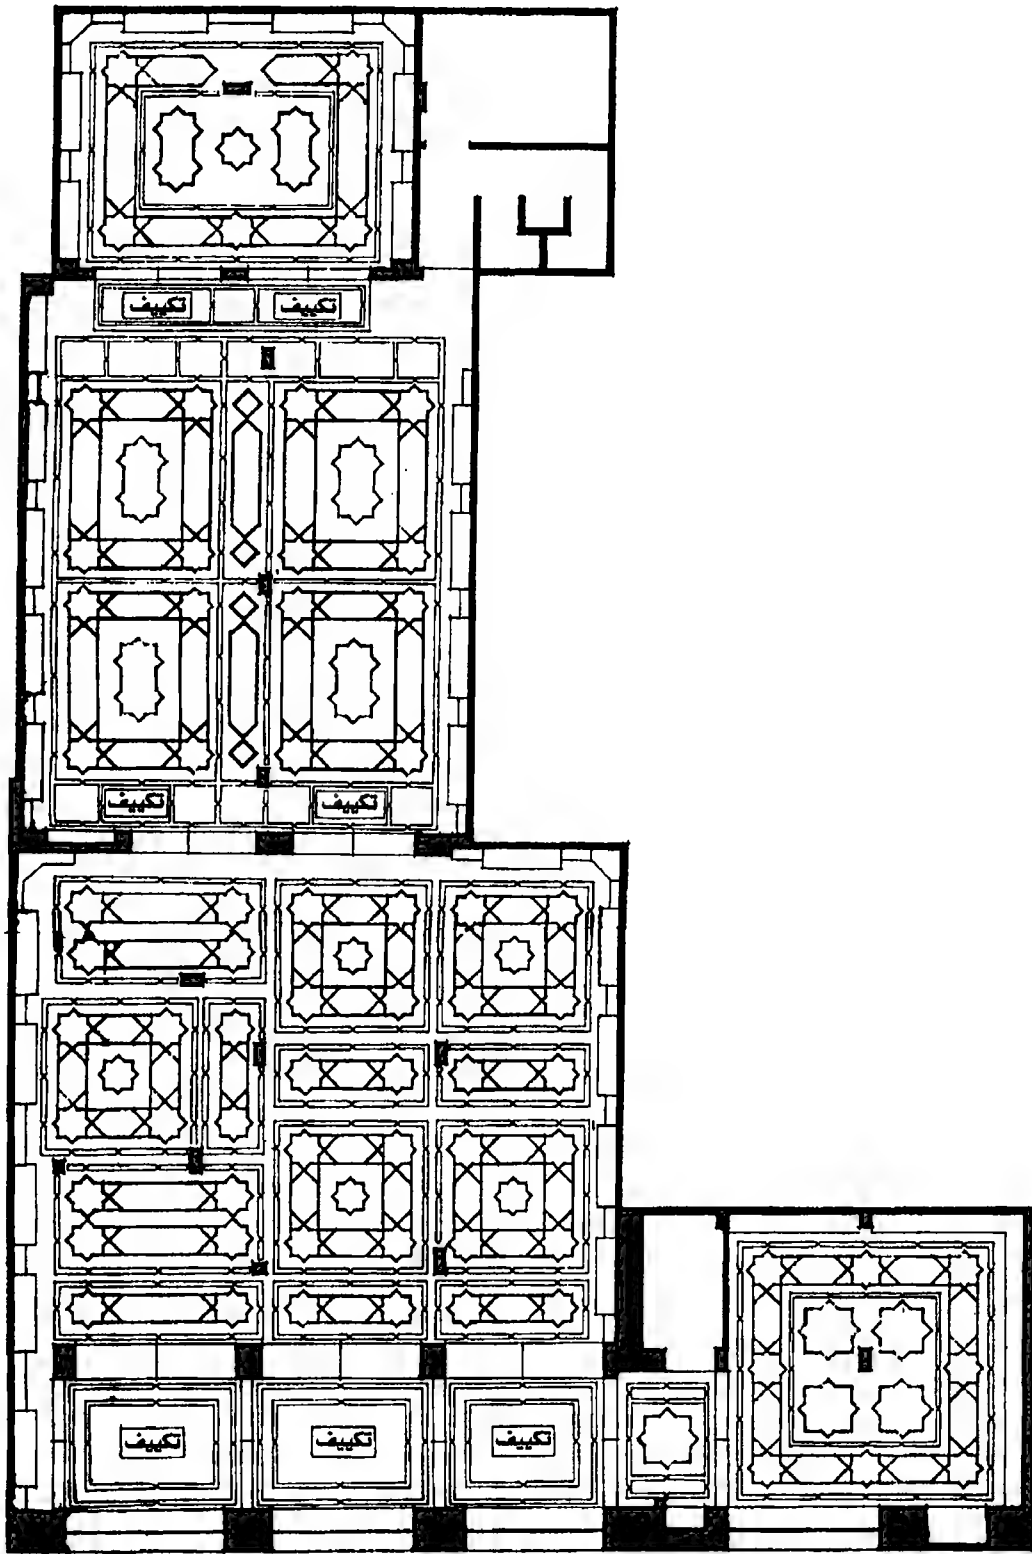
مسقط أفقي سقف خشبي لمحل سياحي بالأقصر (تصميم المؤلف)
